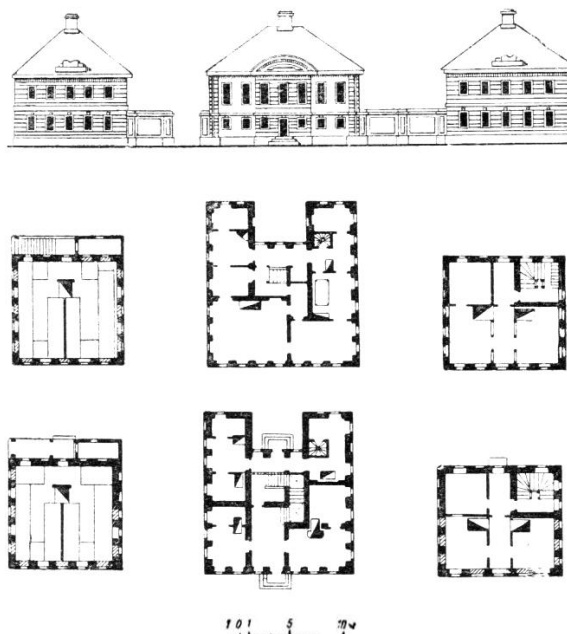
Планы и фасады «казенных зданий» в Полоцке
